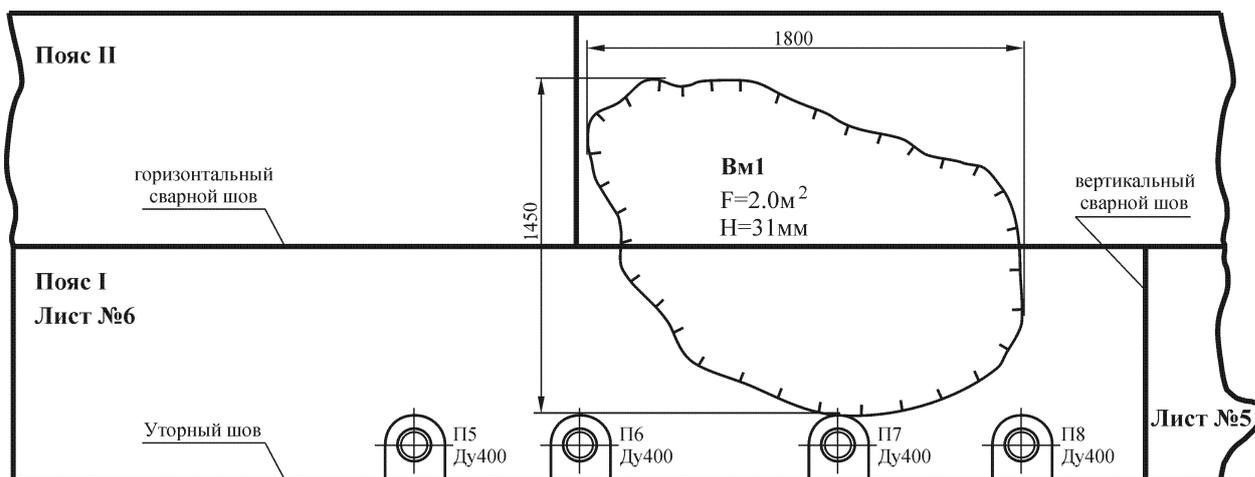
Расположение вмятины Вм1 на стенке резервуара
